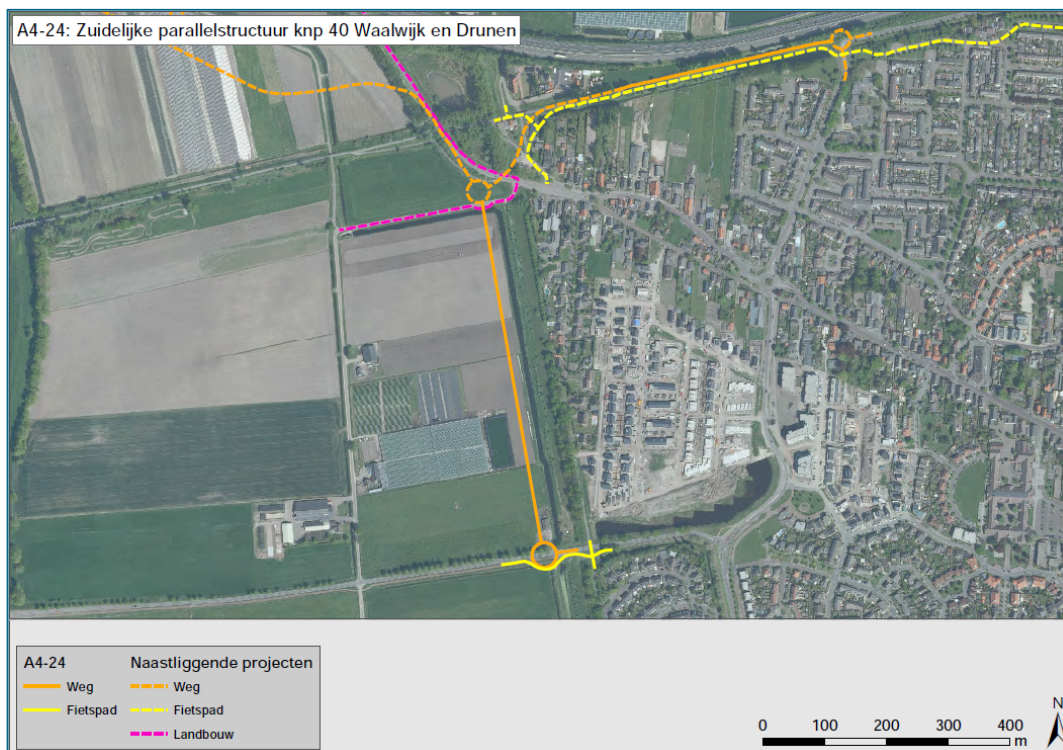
Reconstructie aansluiting 40 Drunen-West.
